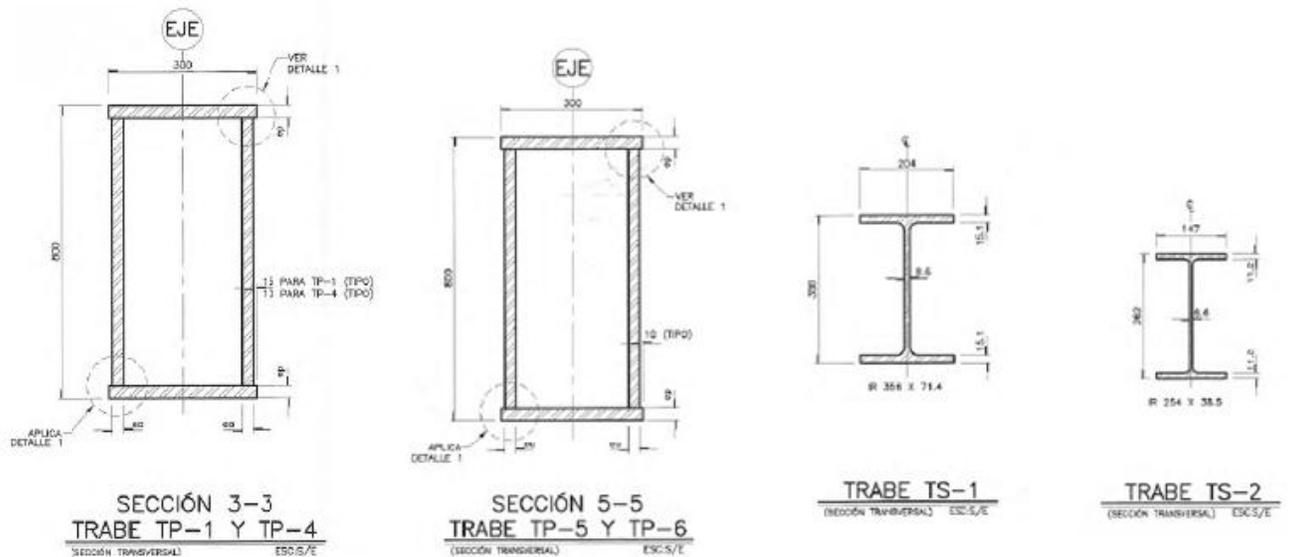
Sección traveses tipo cajón longitudinales y transversales principales TP-1, TP-2, TP-5 y TP-6, traveses secundarios transversales perfil IR TS-1 y Traveses TS-2
